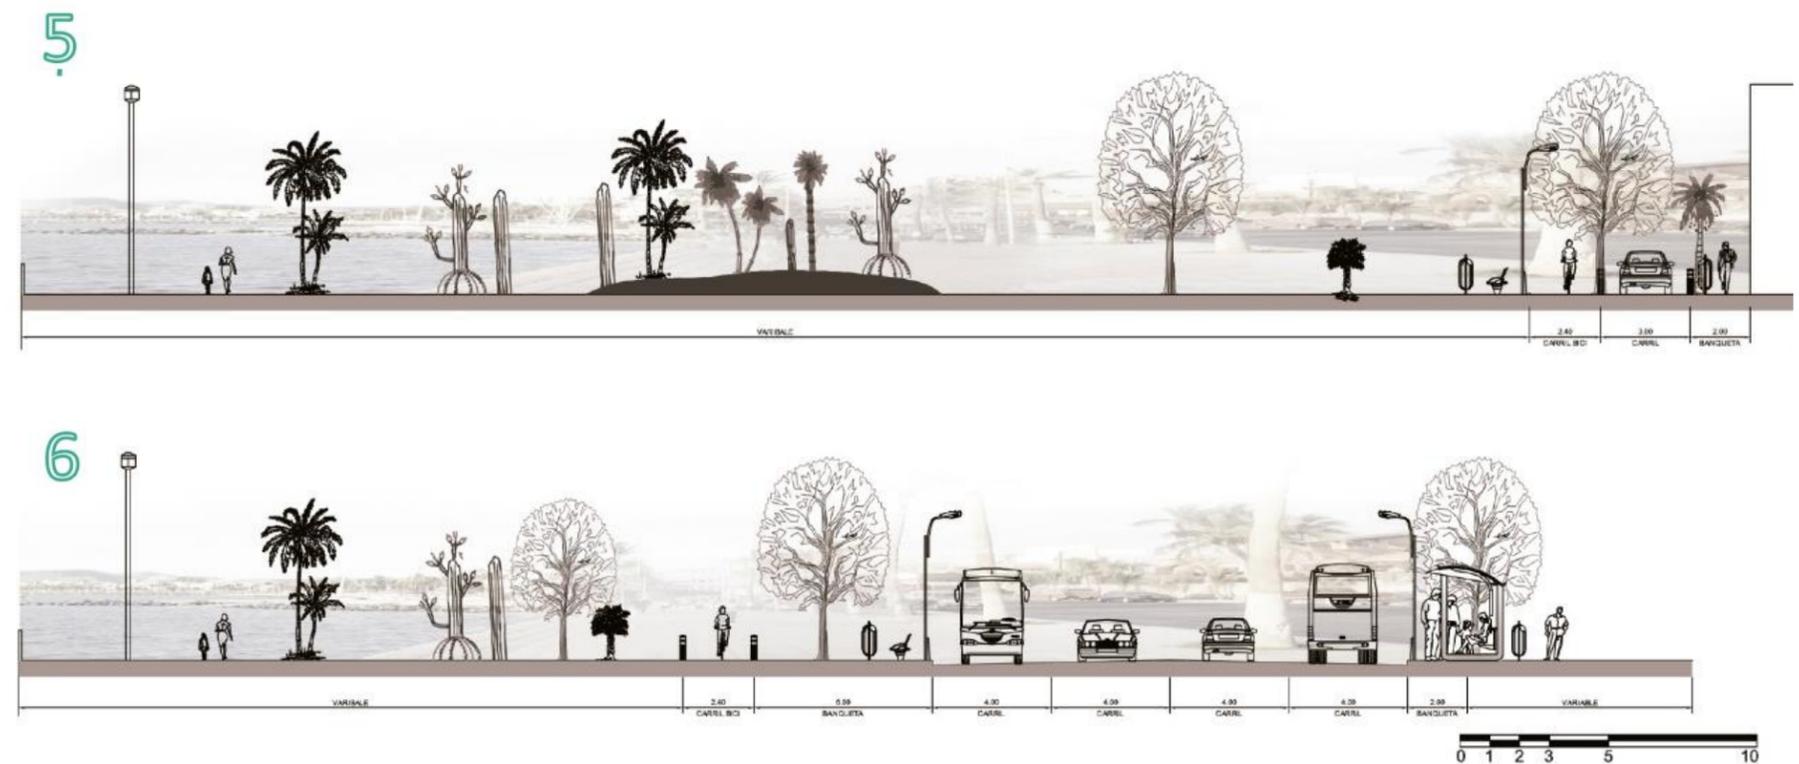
Secciones 5 y 6 de la propuesta del Malecón. Fuent : Elaboración propia(Ver imagen 3-29)
